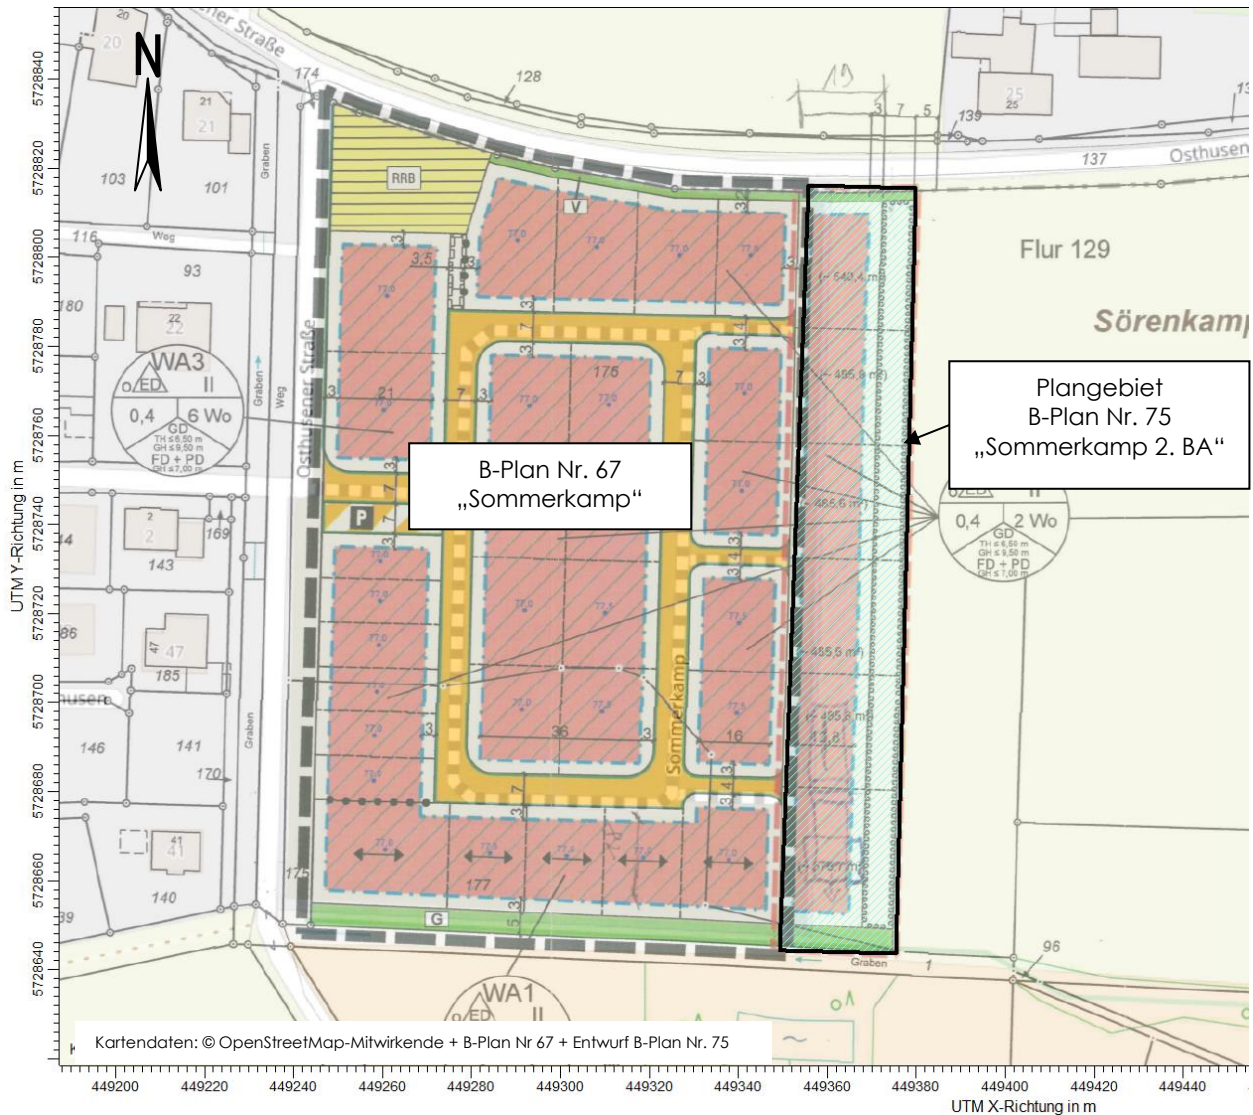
Lageplan des Plangebietes Nr. 75 „Sommerkamp 2. BA“
